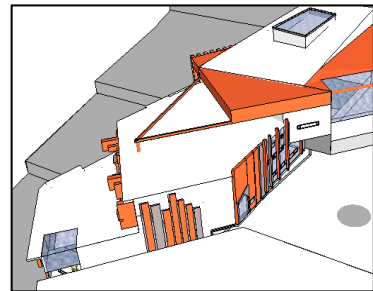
Traitement de la façade ; (Source : auteaures.2020)
